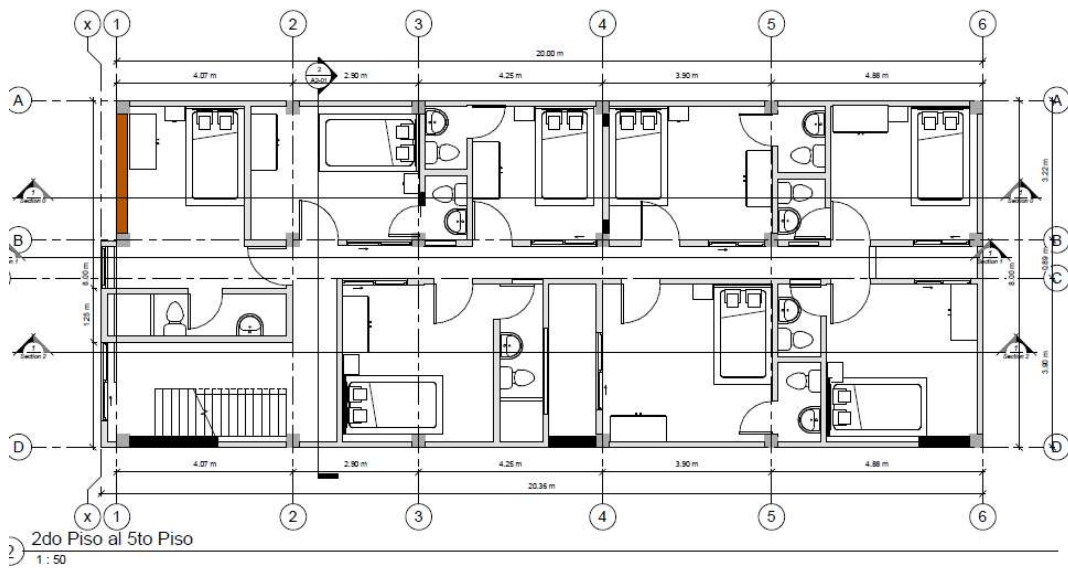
Corte de planta 2, 3, 4, 5 pisos Albañilería Reforzada Fuente Propia
